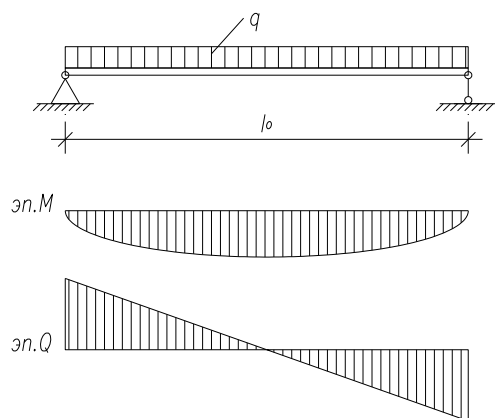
Расчетная схема плиты и усилия эп.М и Q
